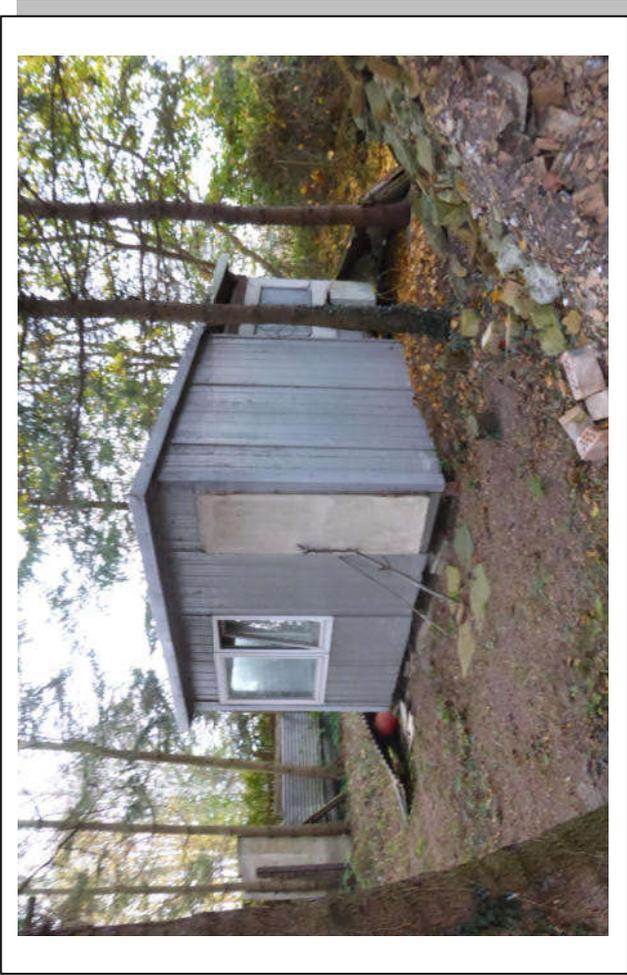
o links und rechts: Ansichten vom Gebäude 4: Wohnanhänger mit Vorbau/Abdachung
